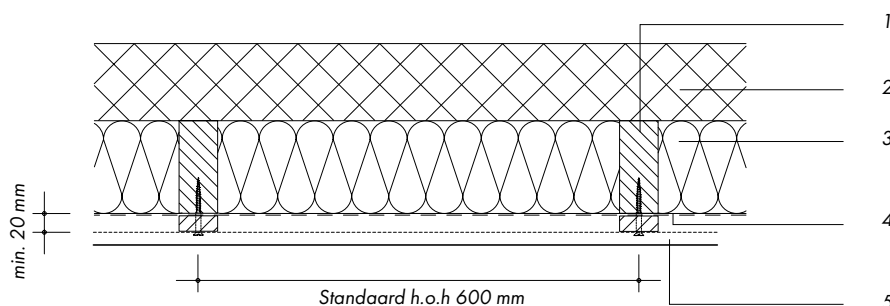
achterconstructie hout RHEINZINK-fels-, roeven- en losangegevel (verticaal detail)
